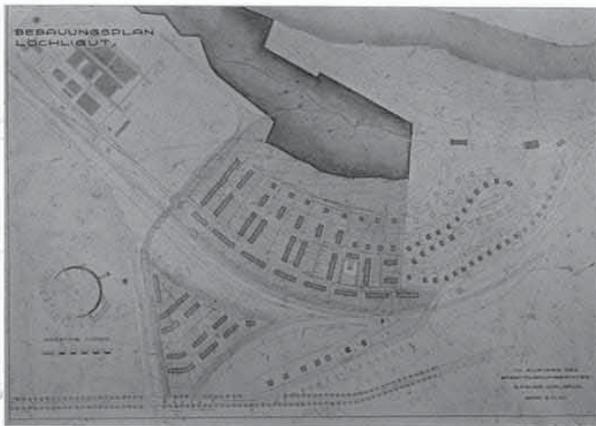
Bebauungsplan Löchligut, Architekt P. Favre, 2.11.41
